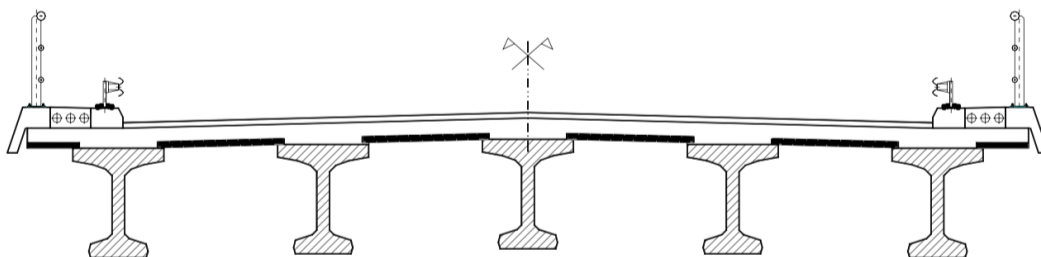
Secção transversal do tabuleiro de uma Ponte com vigas em “I” [8]
